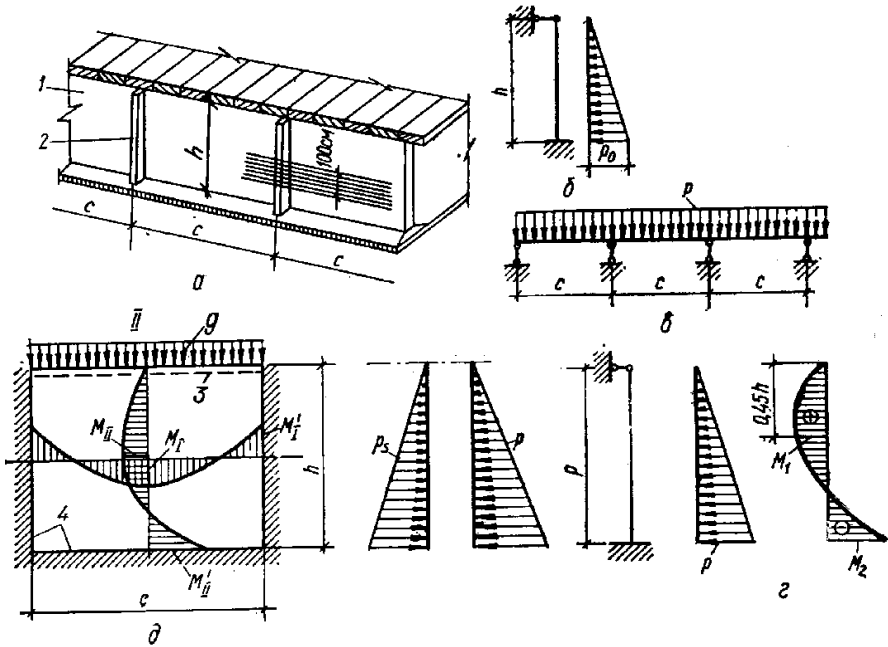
До розрахунку прямокутних закритих резервуарів:
